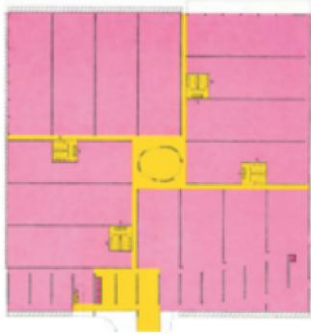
Planta Centro de Cálculo Olivetti (1962)
